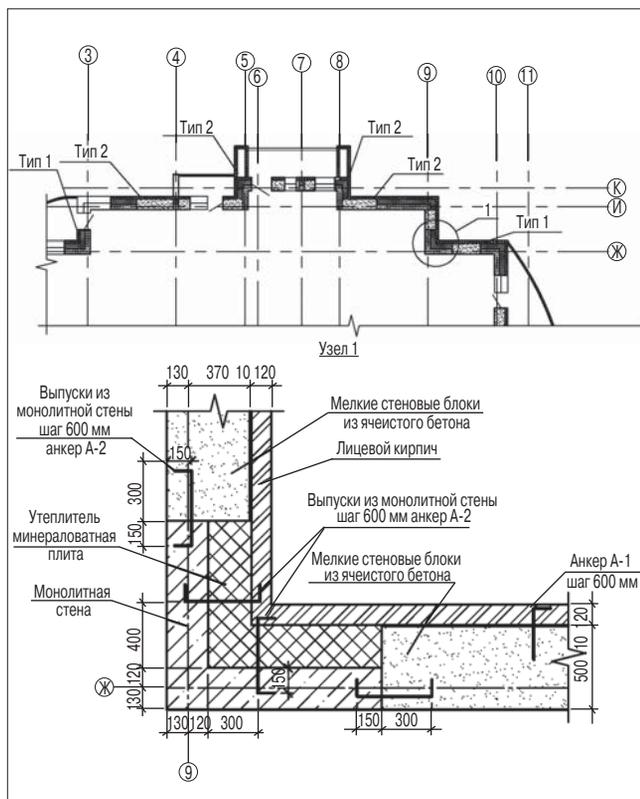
Фрагмент плана типового этажа здания с наружными многослойными стенами
